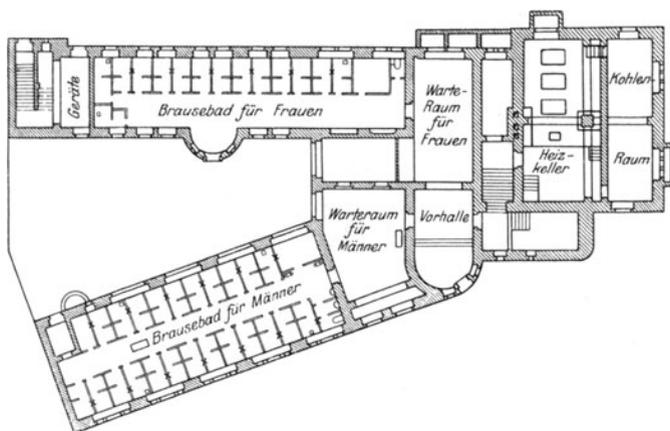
Grundriß eines öffentlichen Brausebades in Breslau.
